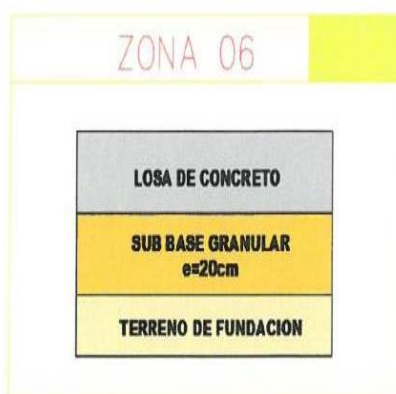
Sección recomendada de pavimento ZONA 06. Fuente: Elaboración Propia.
